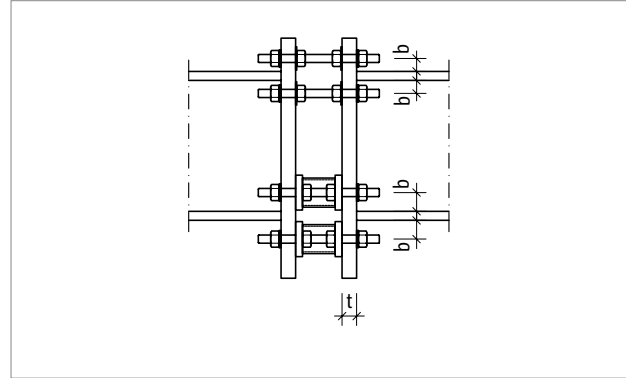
Plaque frontale T type S : tableau de valeurs de départ géométriques ; coupe
